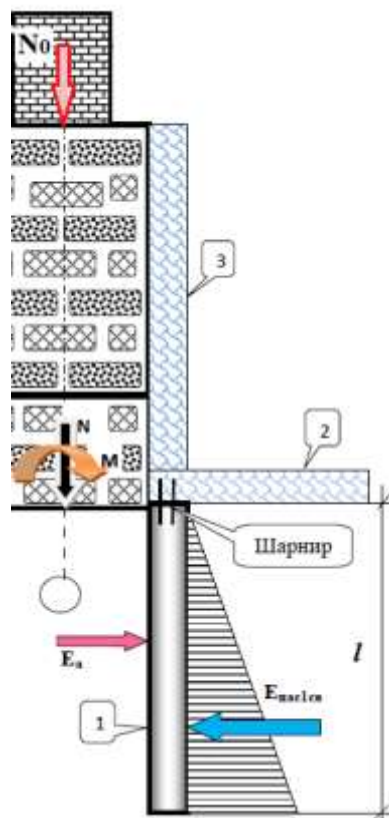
Схема поперечного сечения фундамента реконструируемого здания для расчётного обоснования необходимого числа микро свай усиления основания.
